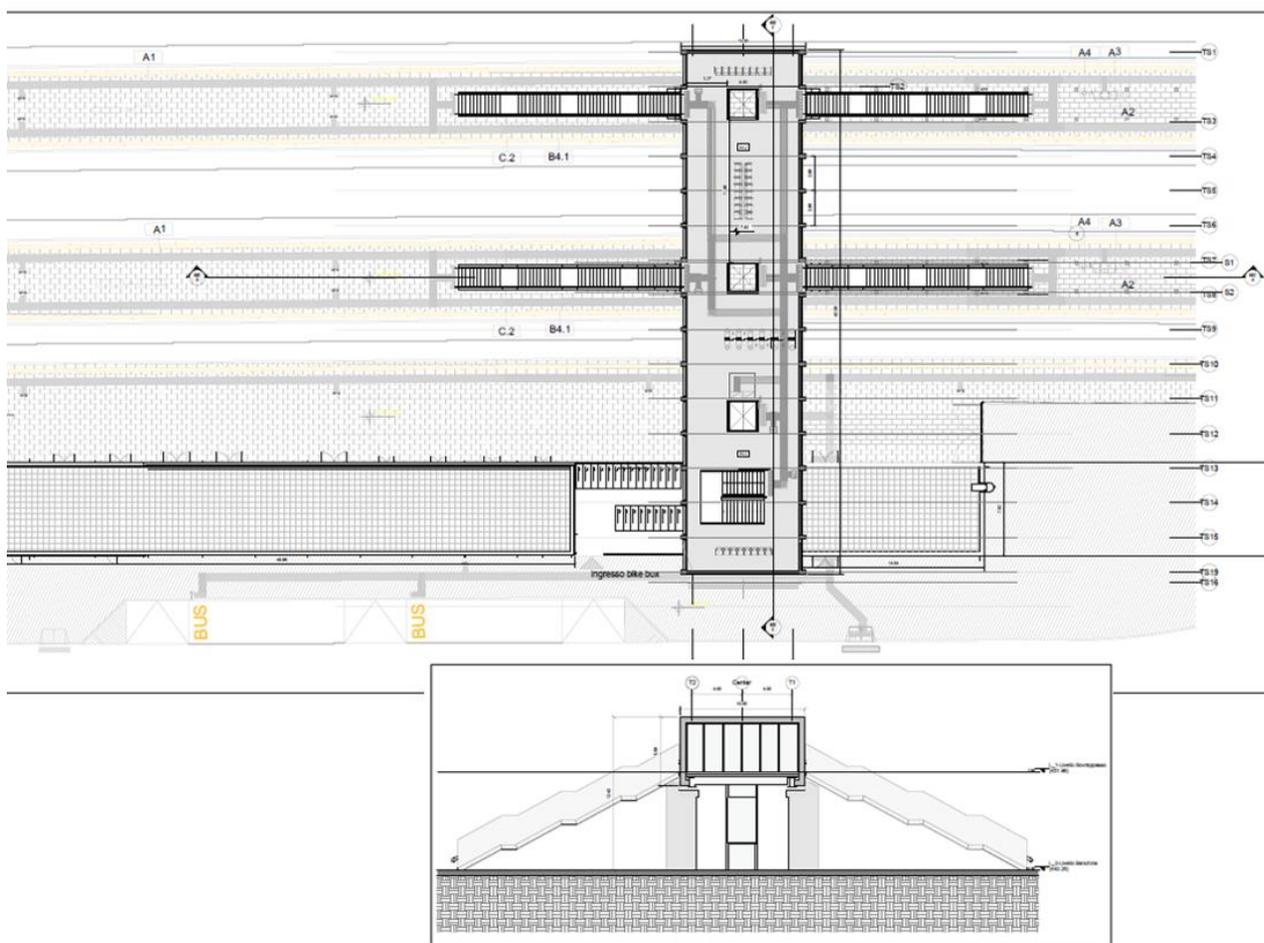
Stazione di Vallelunga – pianta e sezione sovra-passo
